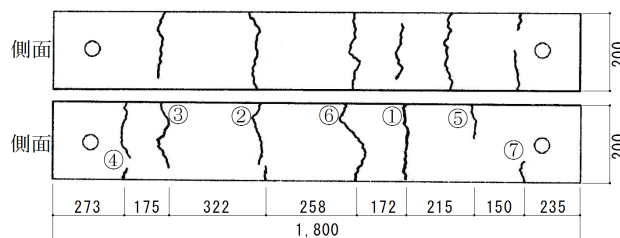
(b) ひび割れ状況 補強鉄筋(2-3)
